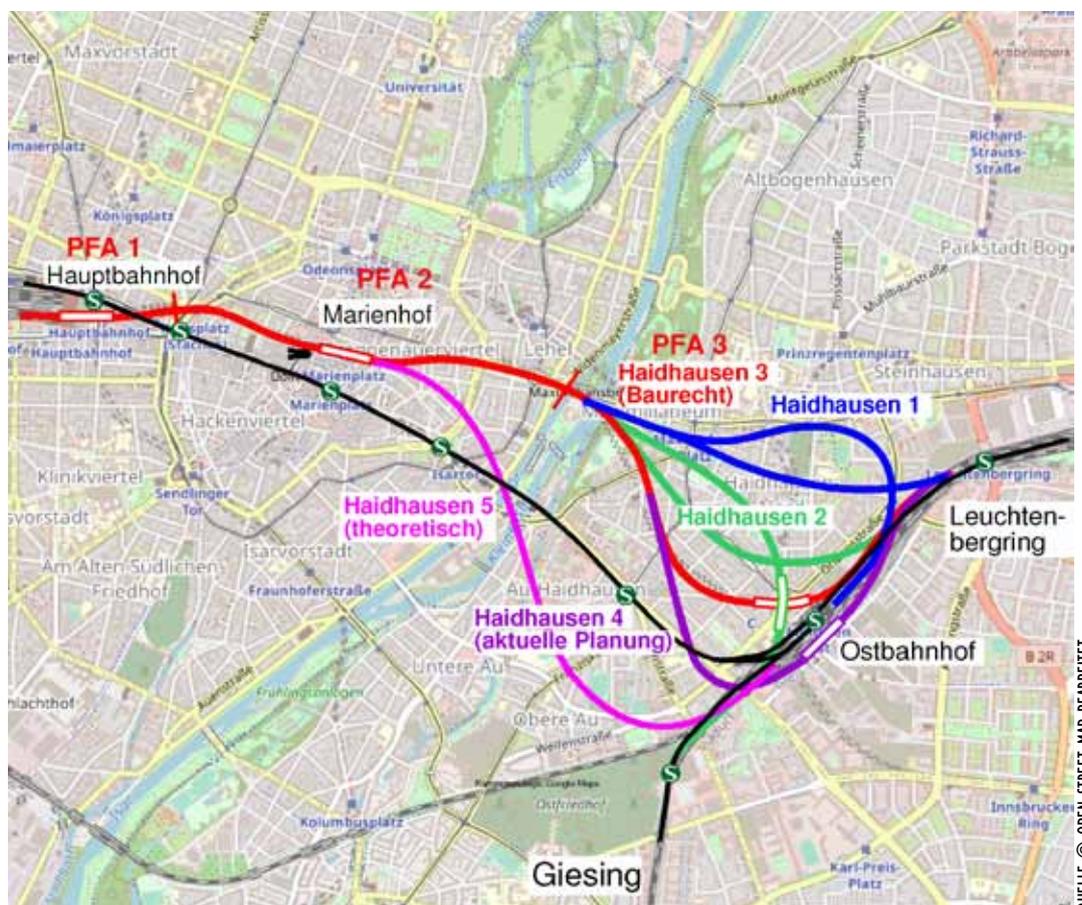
Diverse Planungen zur Streckenführung im Stadtteil Haidhausen
